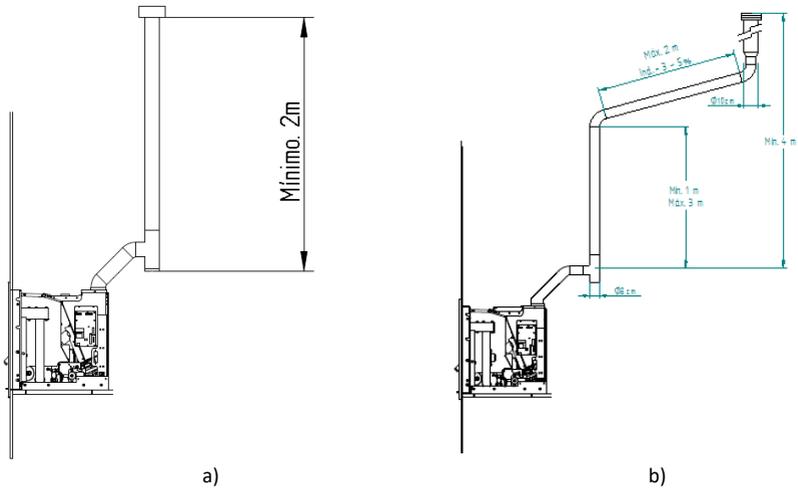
Exemple d'un conduit extérieur, avec trappe de visite.
